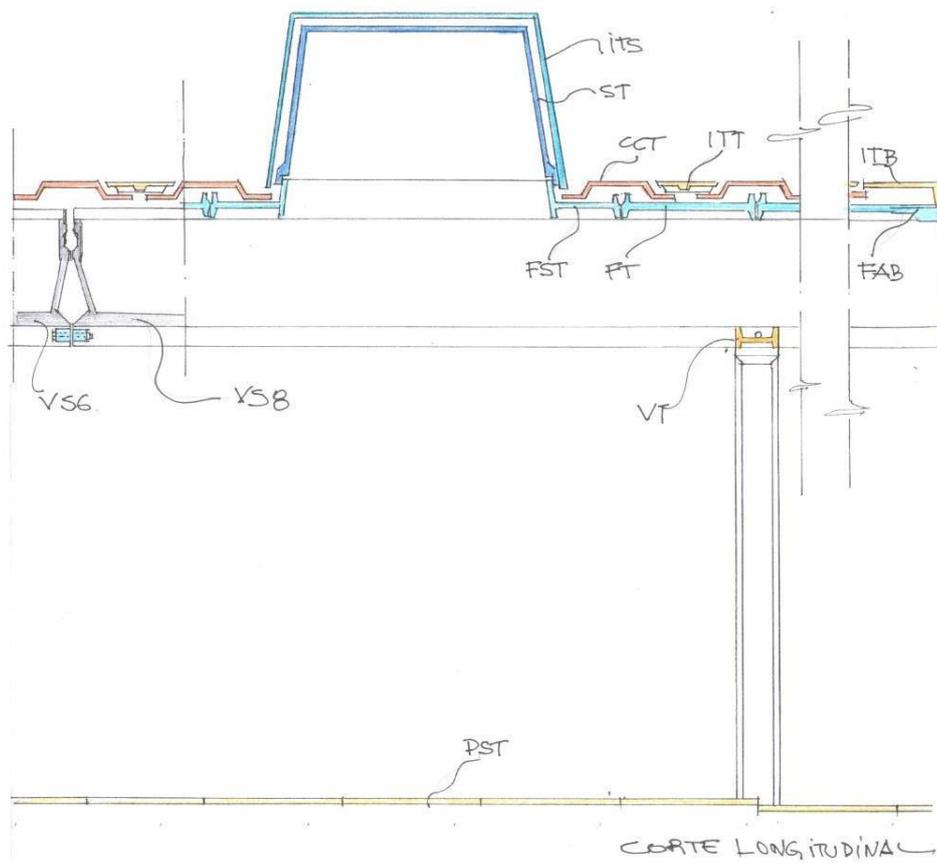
Corte Longitudinal ao Módulo Tipo, lado interno, do piso até a cobertura. Desenho do autor.
